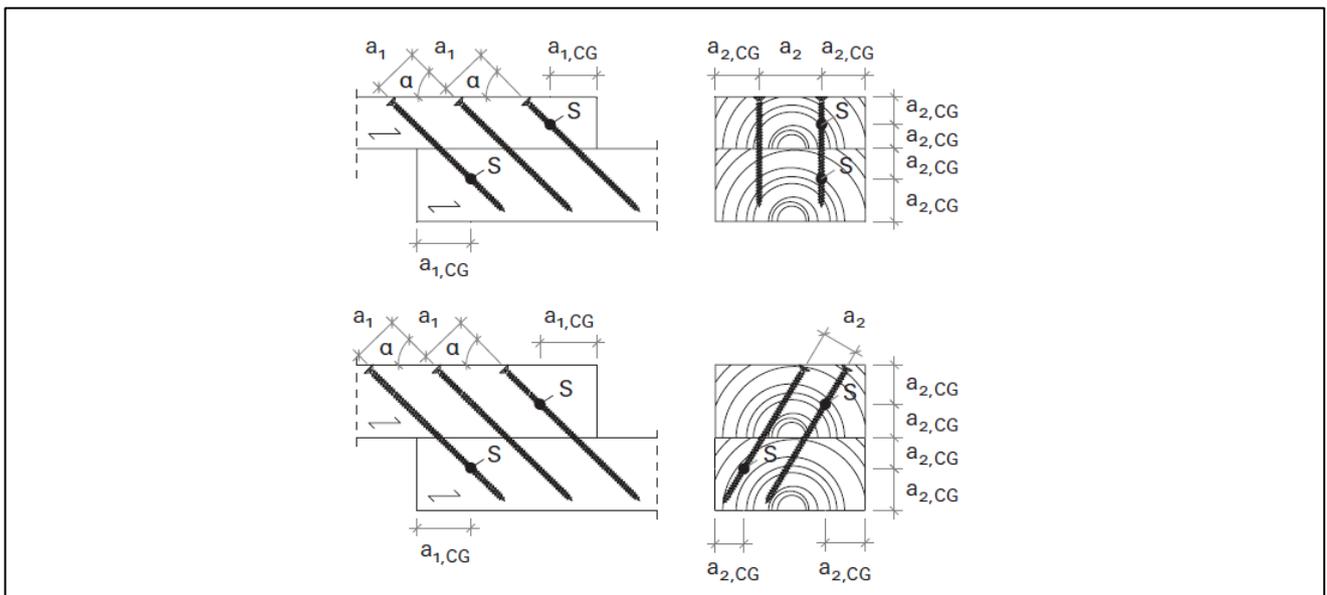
Definition der Mindestabstände für axial belastete ASSY Schrauben gemäß ETA-11/0190.
